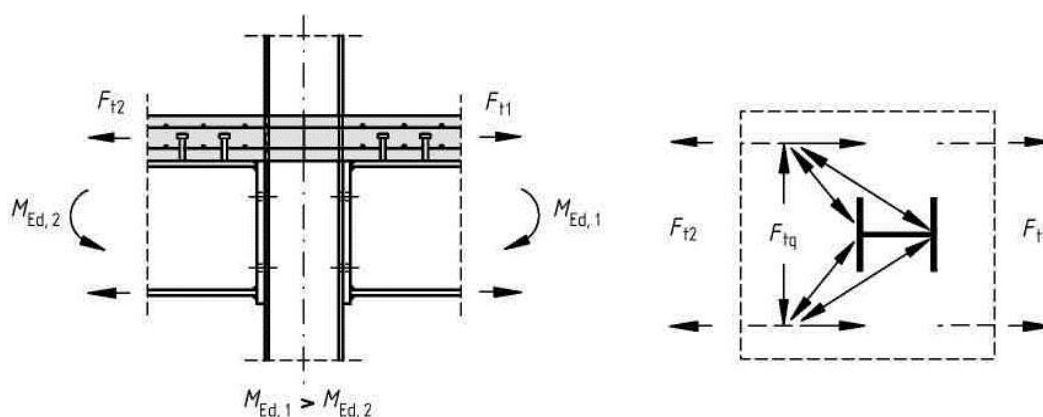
Модель стержневой аналогии передачи усилий с бетонной плиты на колонну
